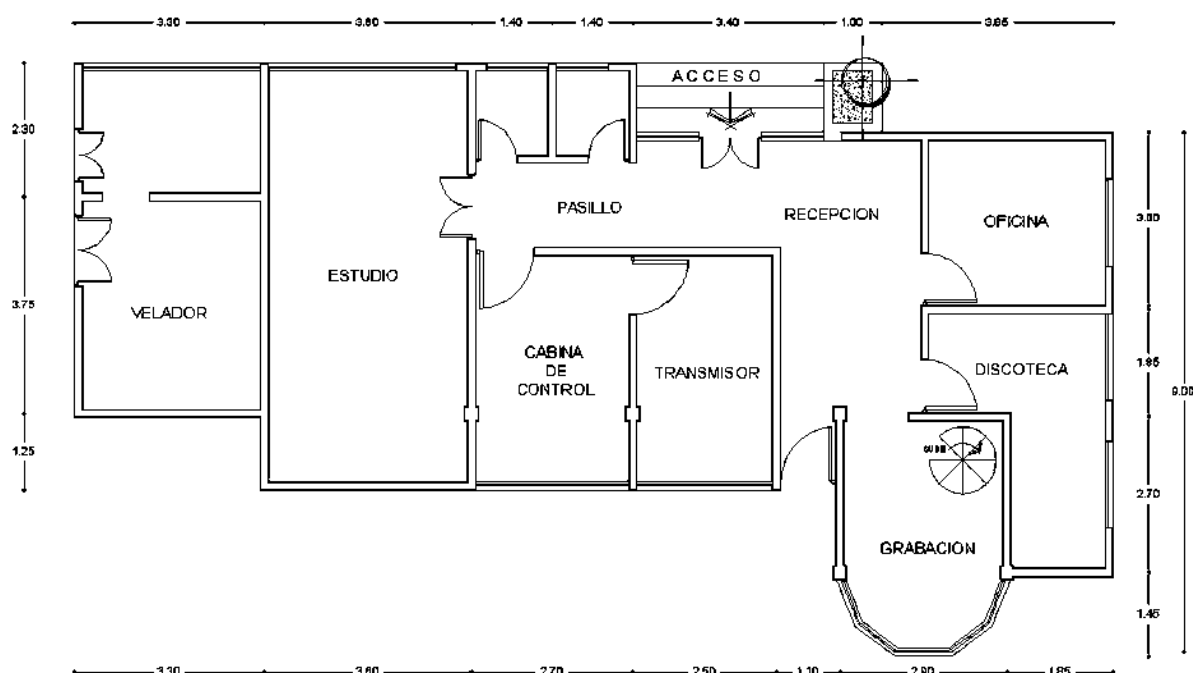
Planta baja de la actual sede de Radio Nicolaíta.
